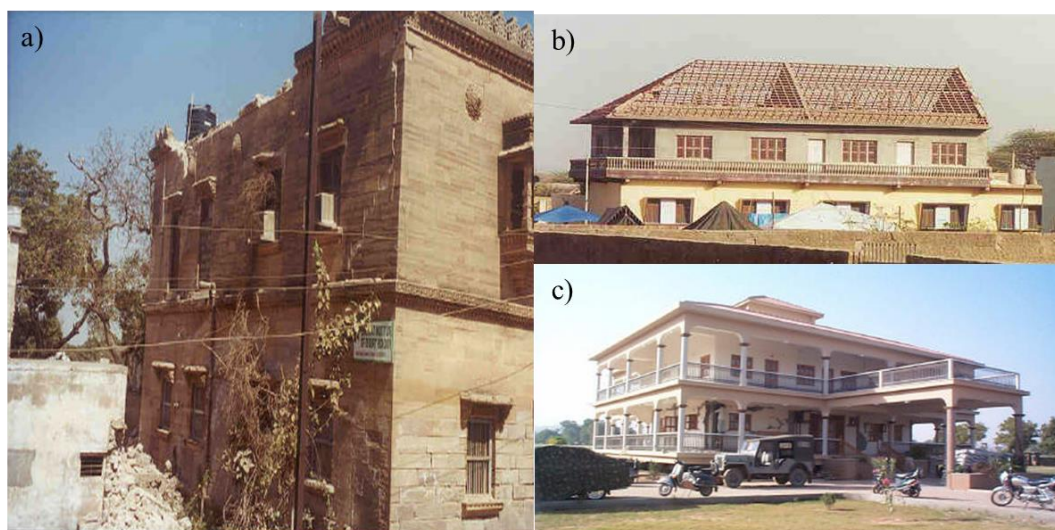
öffentliche Gebäude in Indien (Patel, et al., 2001): a) um 1900 erbautes 2-geschossiges Regierungsgebäude aus Ziegelstein in Bhuj, b) Gebäude in Mirzapur mit ausgefachten Wänden, c) Stahlbetonkonstruktion in Bharazar
